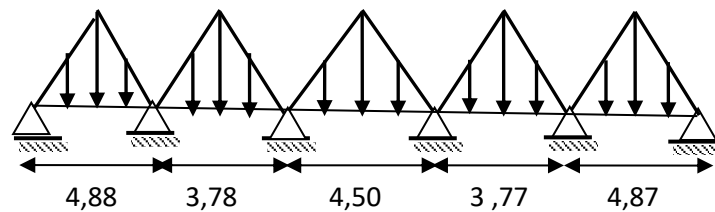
Distribution des charges sur les poutres aux sens secondaires
